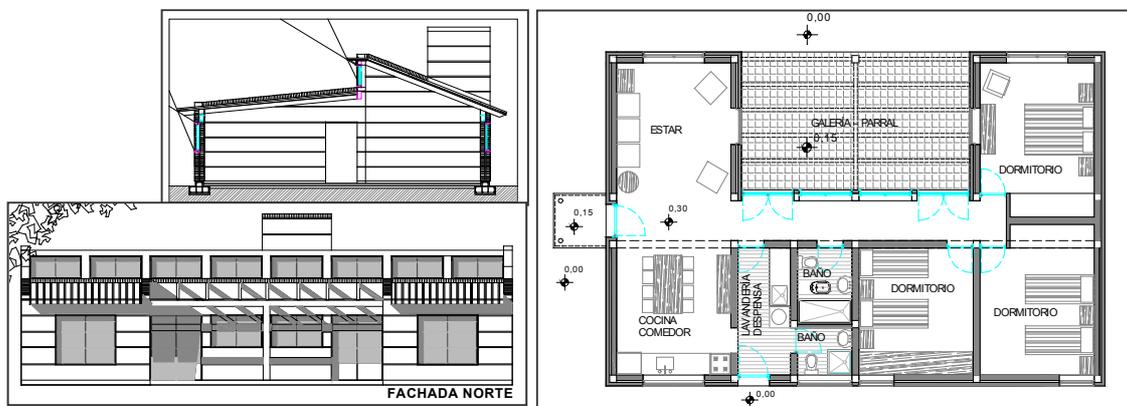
Vivienda analizada: Planta, corte y Fachada Norte
